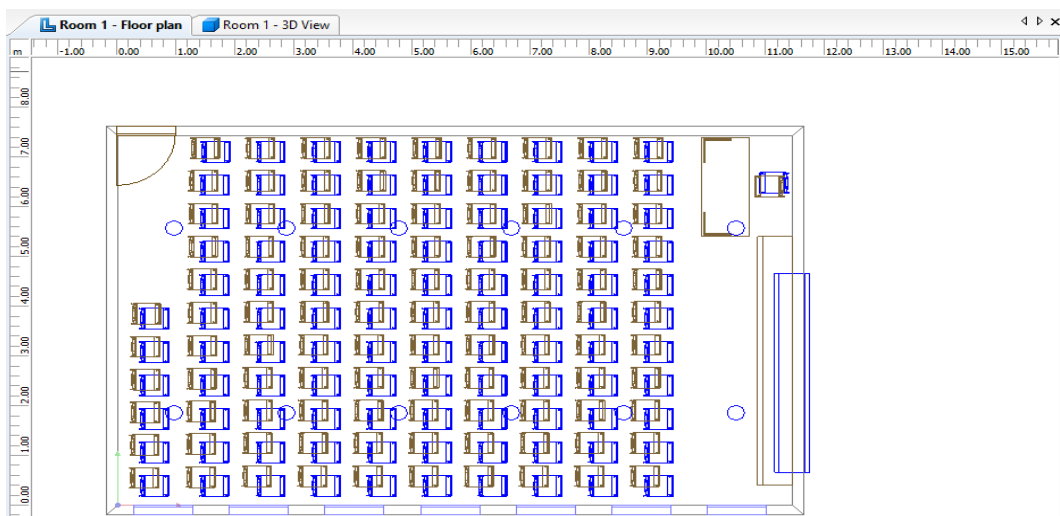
Perhitungan Luminasi Ruang Kelas 4.06 dengan Tinggi 2,80m
